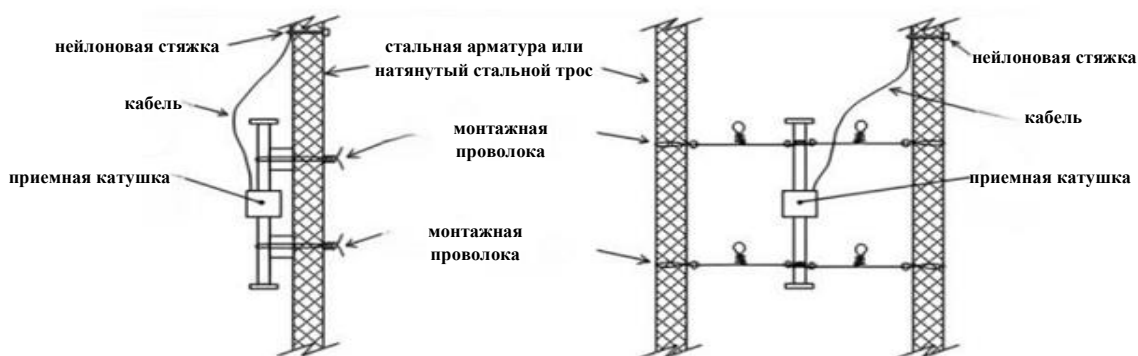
Крепёж ISSO-SG4 к стальной арматуре
